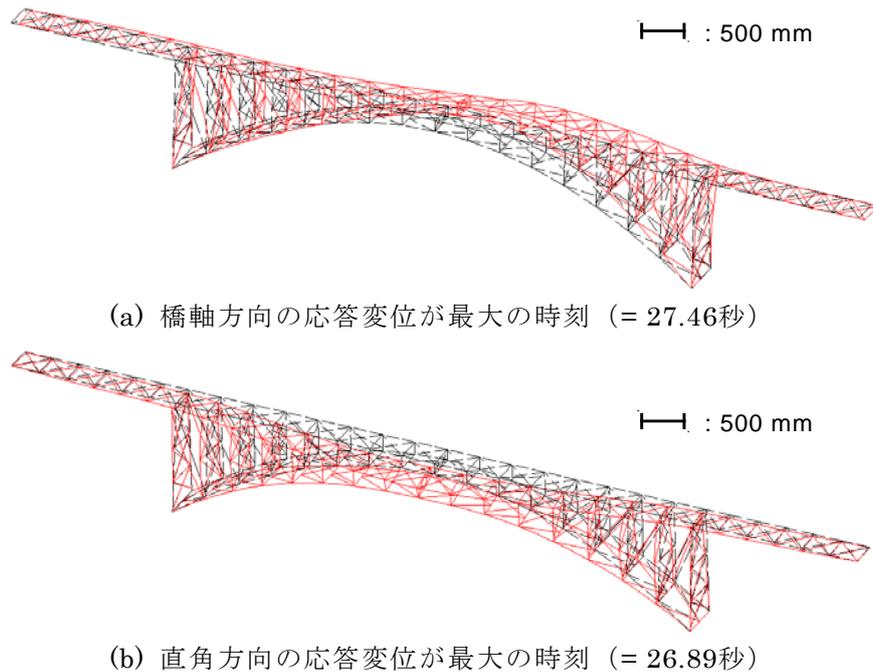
補強後のモデルにおいて応答変位が最大時の変形図
